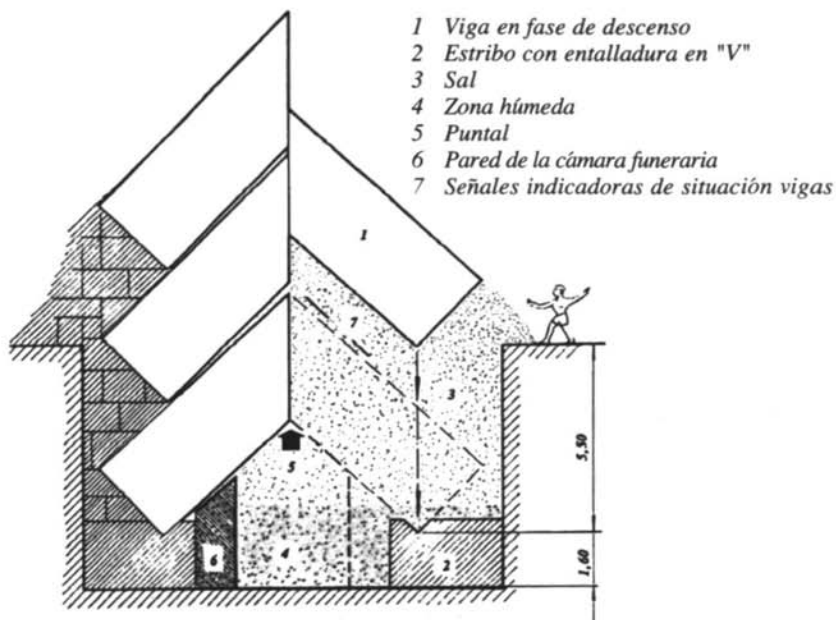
Colocación de vigas apoyadas por el sistema hidráulico de disolución salina
